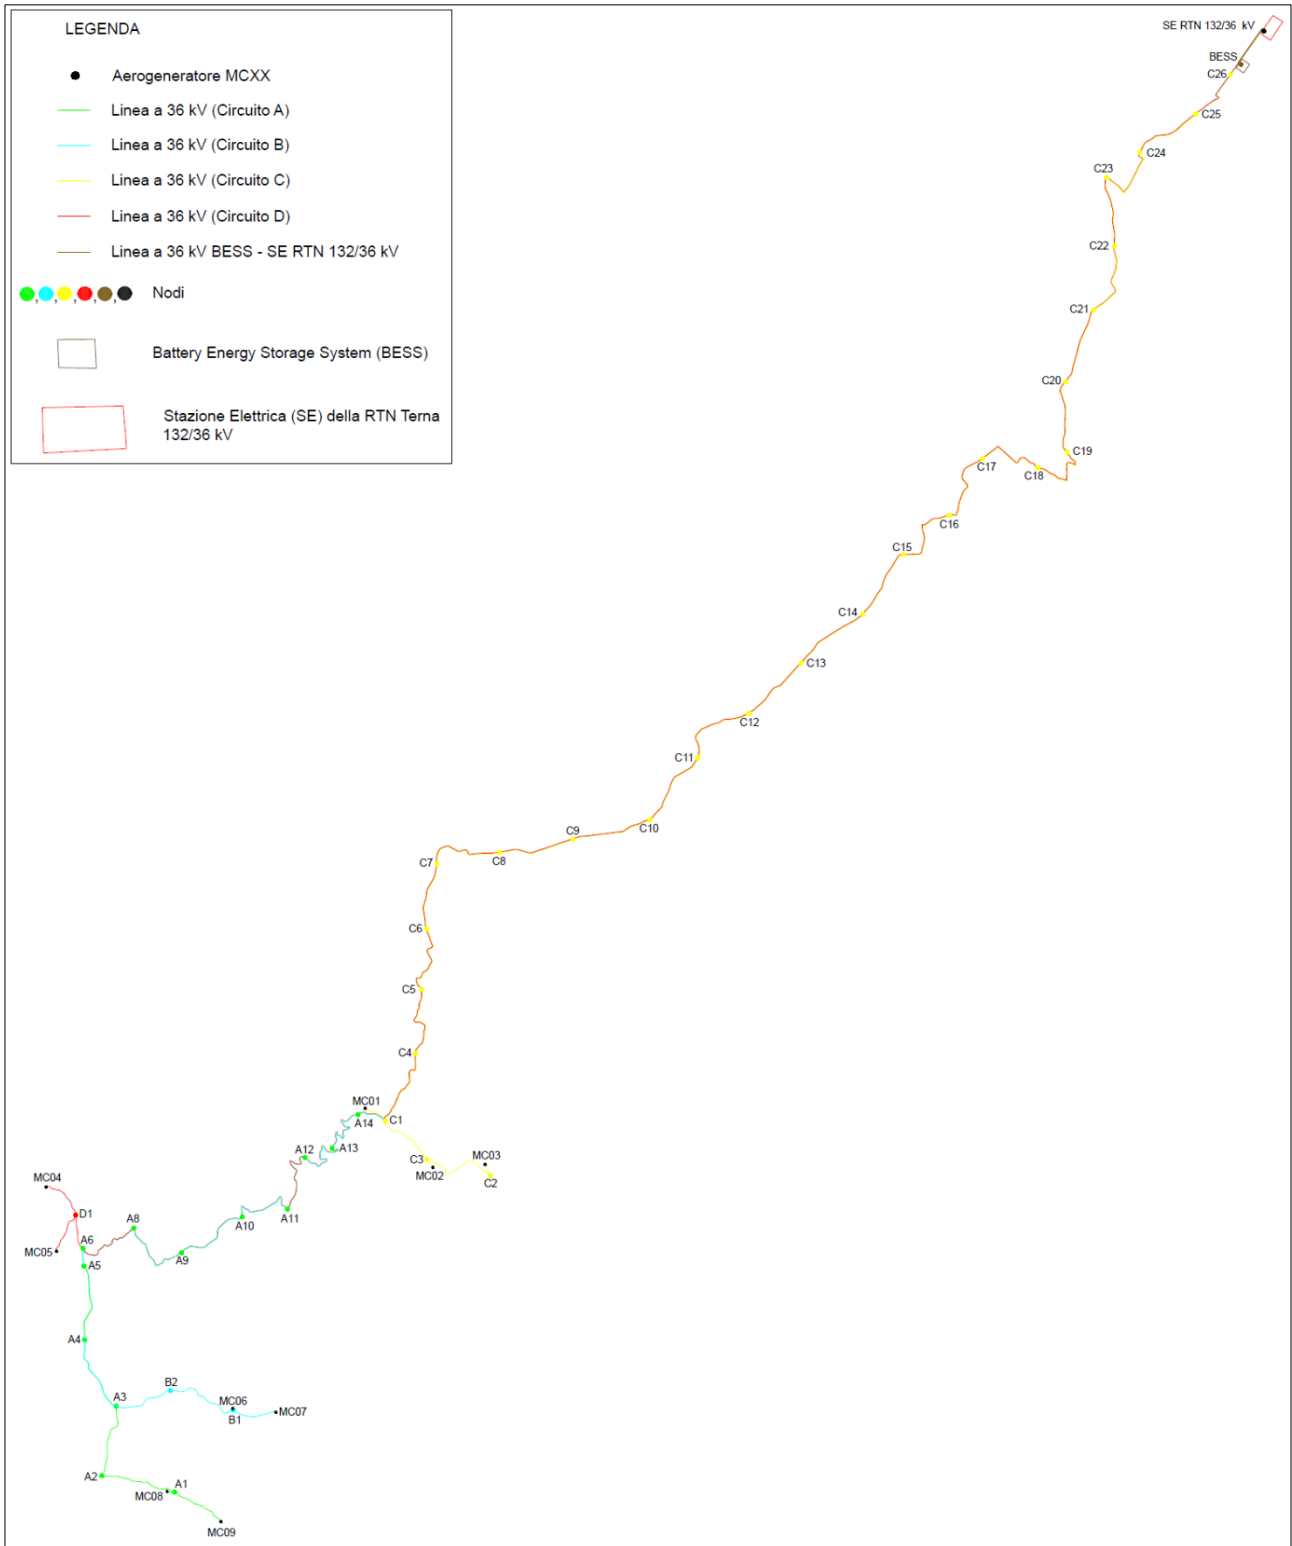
Planimetria di distribuzione linee a 36 kV
